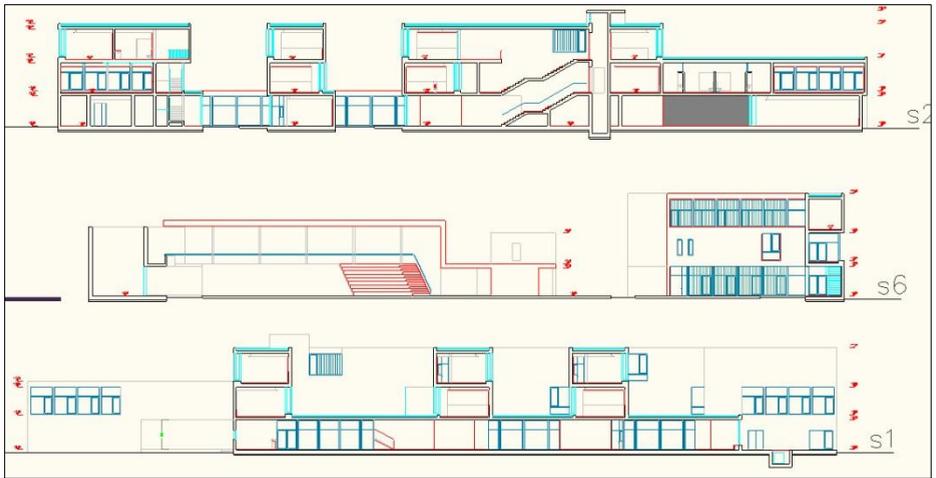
Secciones P. Modificado. Enero 2009. Fuente proyecto de ejecución
